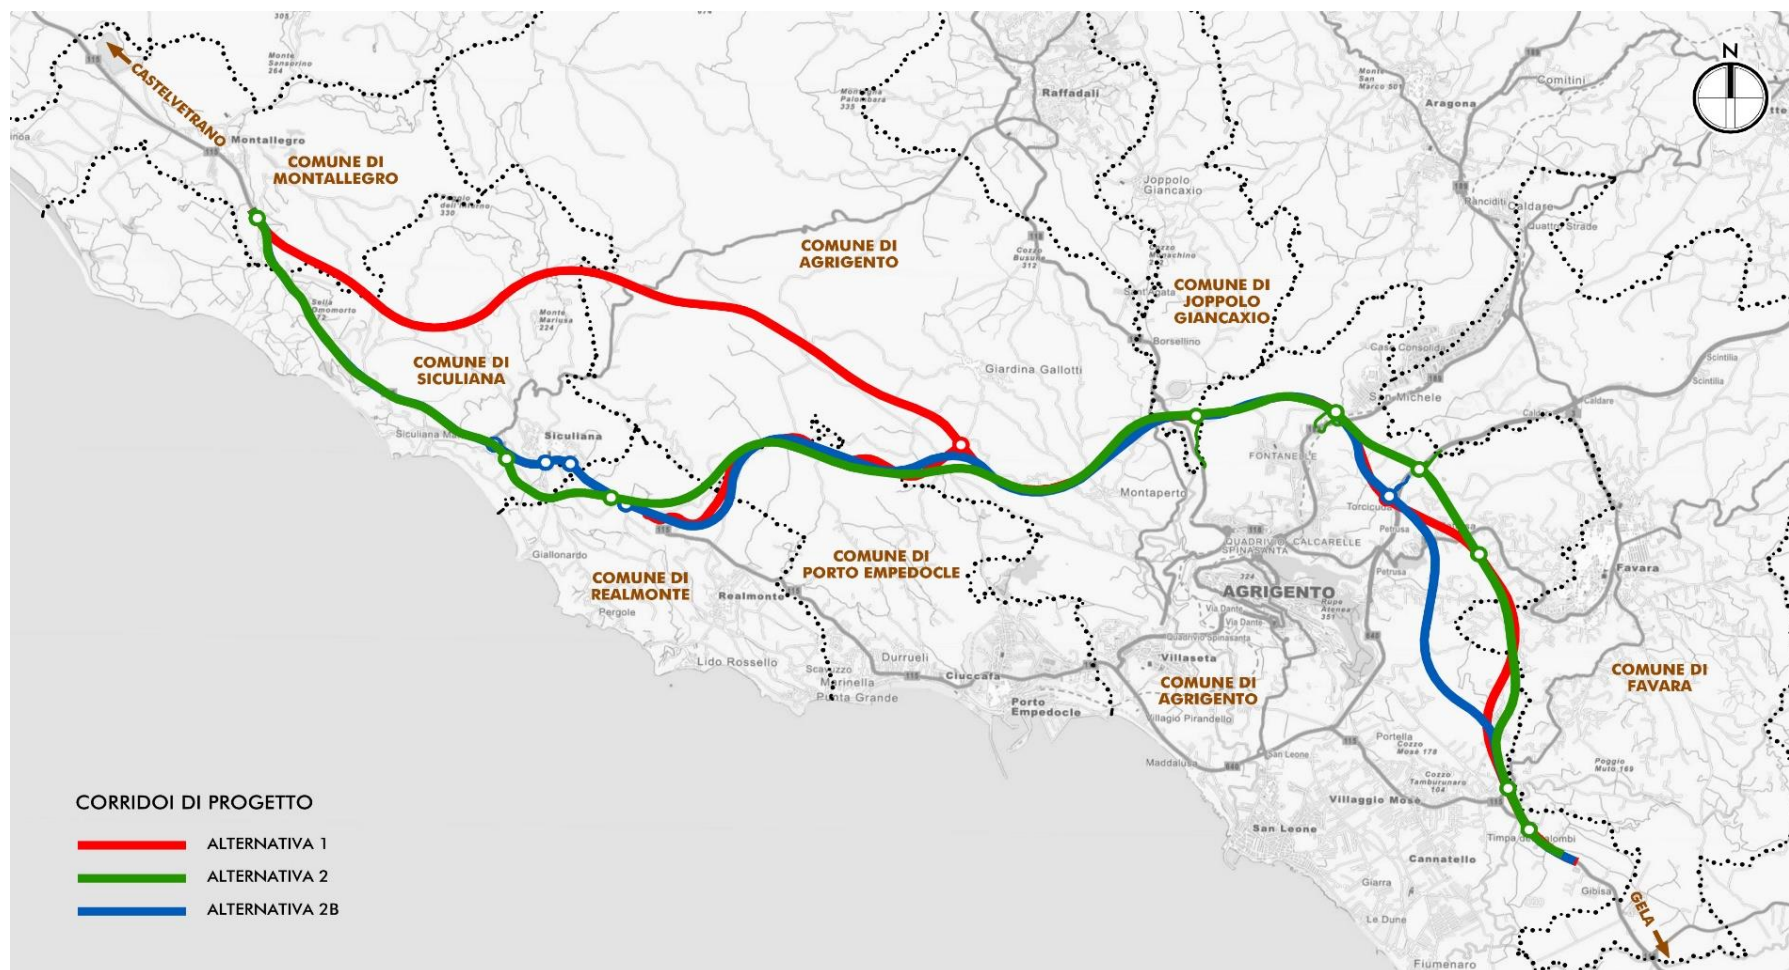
Planimetria generale con individuazione delle alternative di progetto
